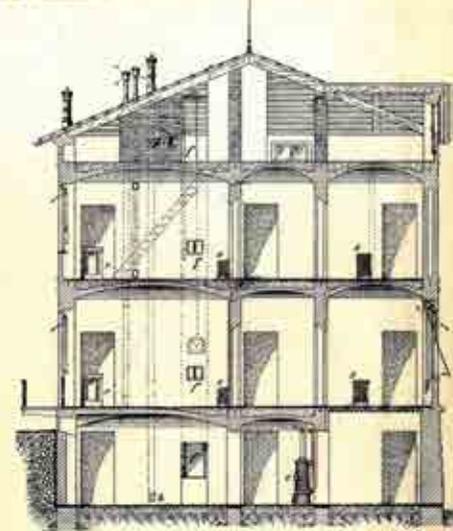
Sezione trasversale E-F (Scala 1:135)
